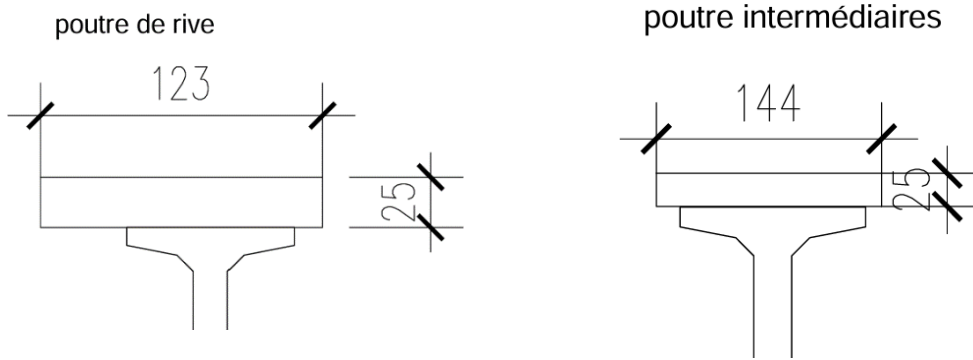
Poutre intermédiaire et la poutre médiane
